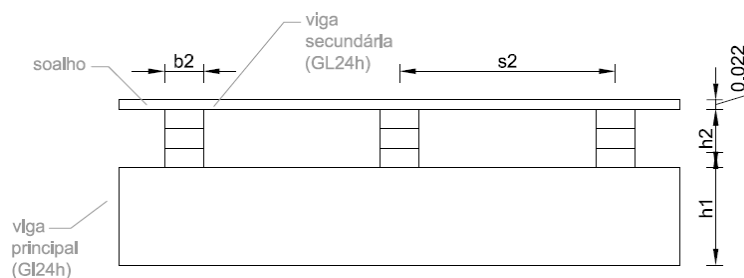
Esquema da solução de madeira lamelada colada S2-B (corte longitudinal).
